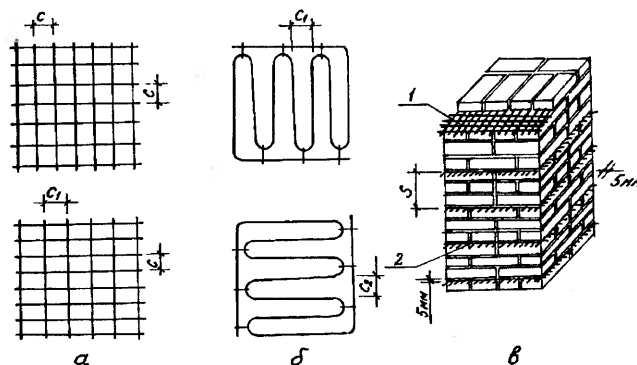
Поперечное сетчатое армирование кладки: а – квадратная (прямоугольная) сетка; б – пара сеток «зигзаг»; в – укладка прямоугольных сеток в швы; 1 – арматурная сетка; 2 – выпуски арматурной сетки для контроля ее укладки
